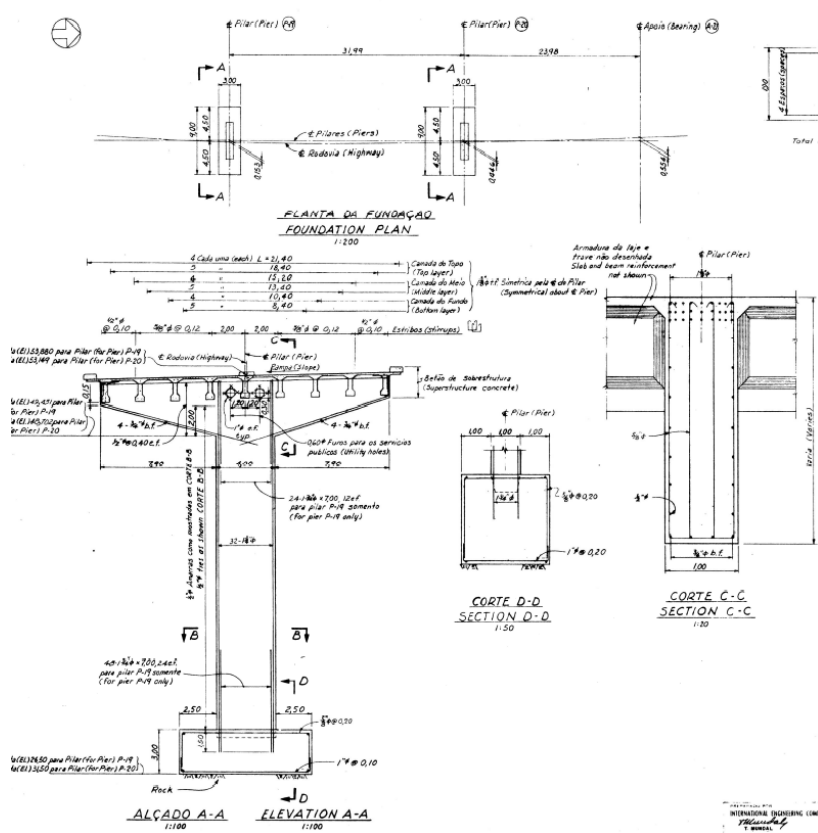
Pilar P19 (Peça desenhada nº C-050 As-Built 1962)
